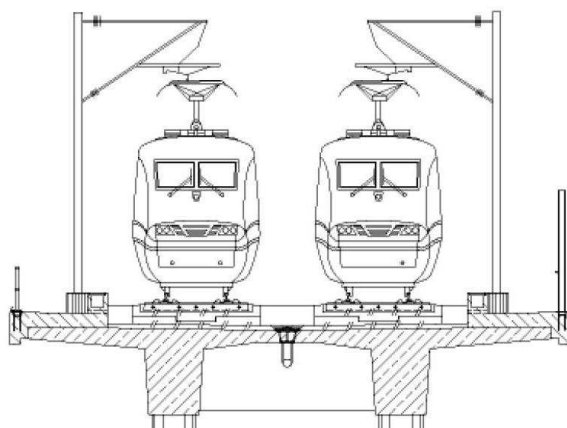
Nejběžnější průřezy betonových mostů používané na španělských VRT
